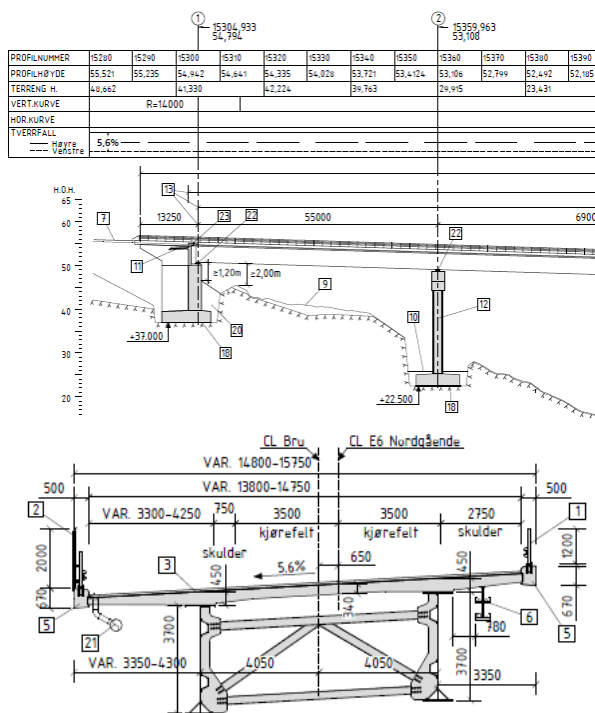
Perfil longitudinal y detalles tipo del viaducto.
